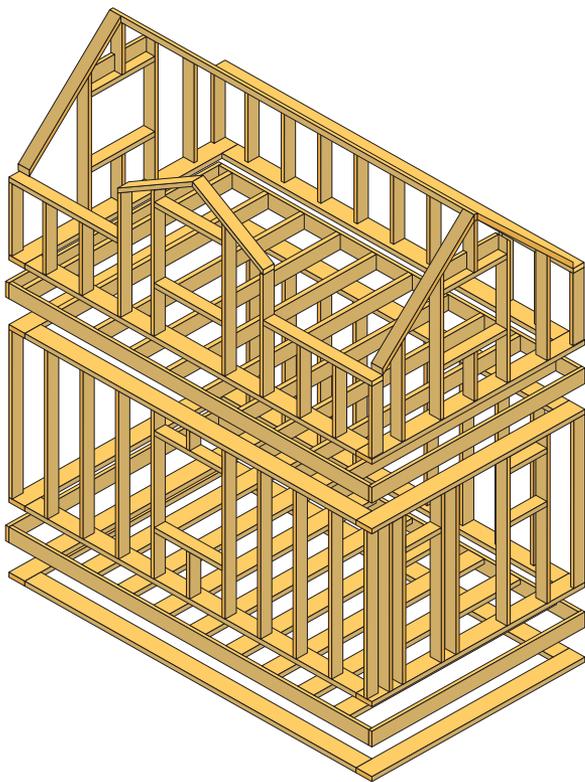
Платформа — рамная конструкция с перекрытием
